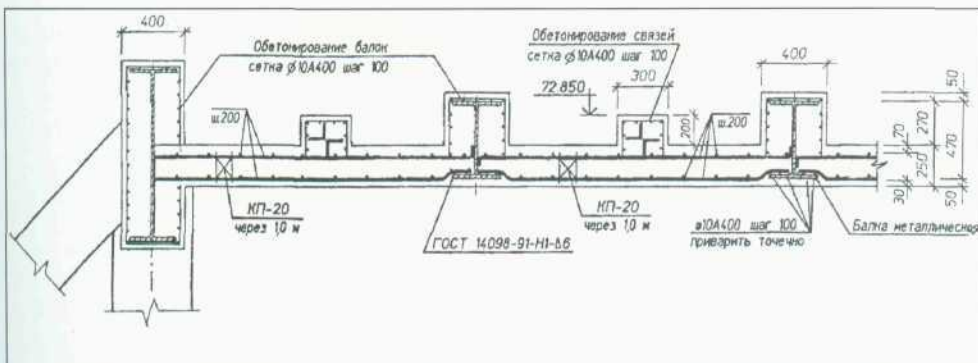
Фрагмент сталежелезобетонного покрытия пространственного каркаса ромбокубооктаэдра на отметке 72,6 м
